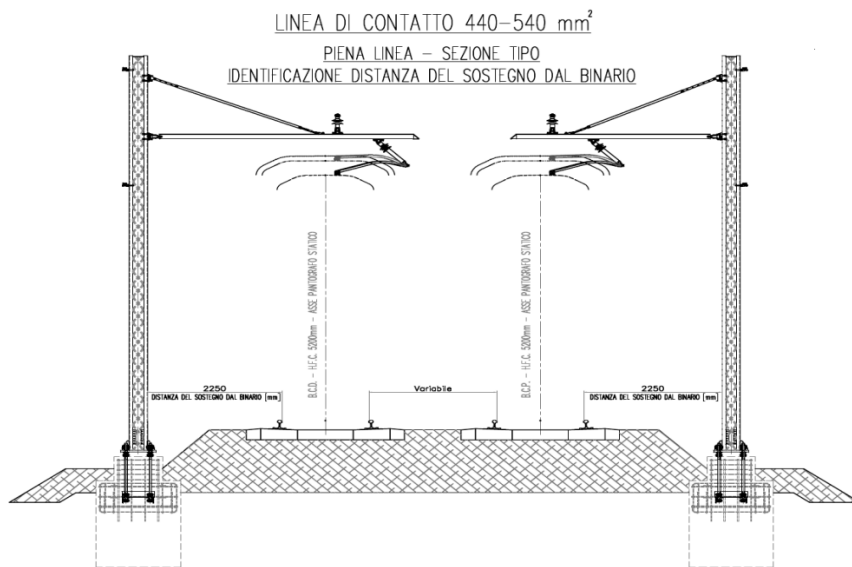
LdC sezione 440 mm<sup>2</sup> – 540 mm<sup>2</sup>
